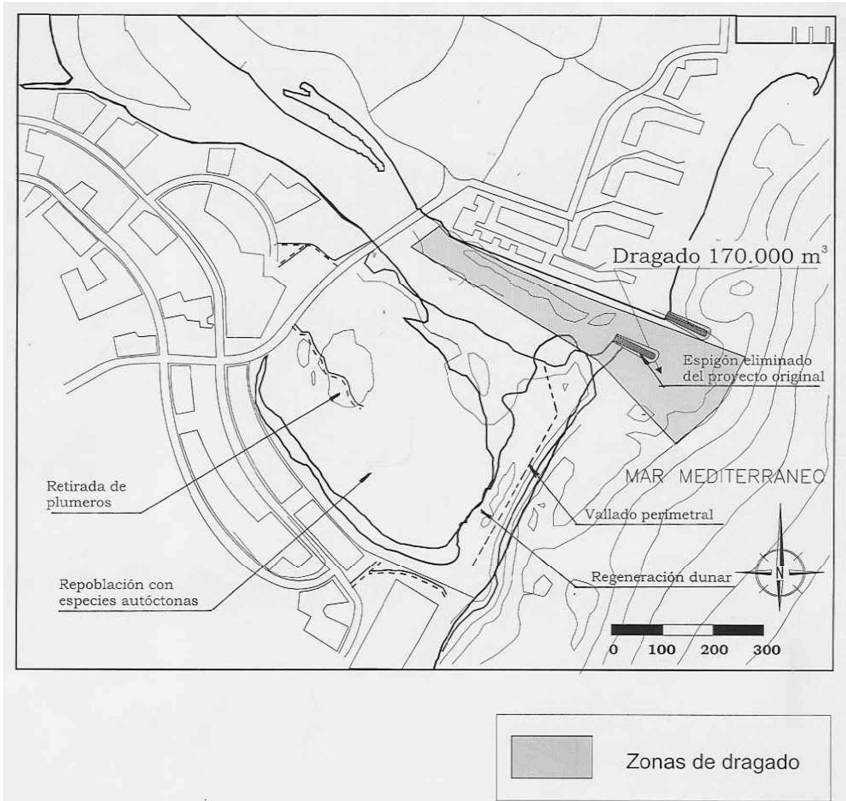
Plano en planta de la zona y de las distintas actuaciones llevadas a cabo.
